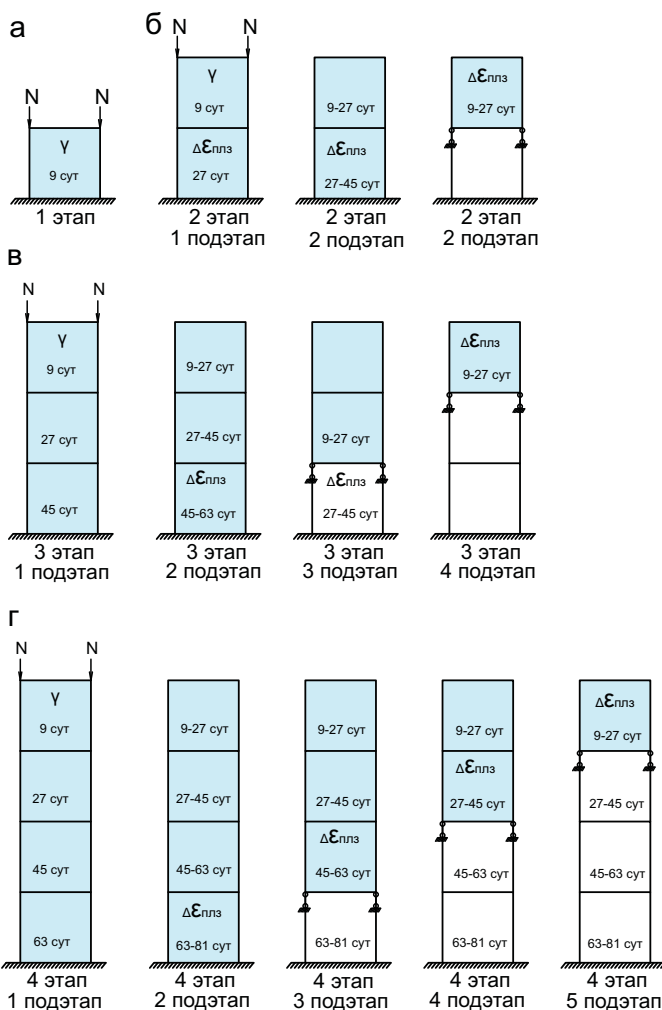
Этапы расчета пятиэтажного фрагмента стены из многослойной кладки с вертикальными диафрагмами: а – 1-й этап; б – 2-й этап; в – 3-й этап; г – 4-й этап
